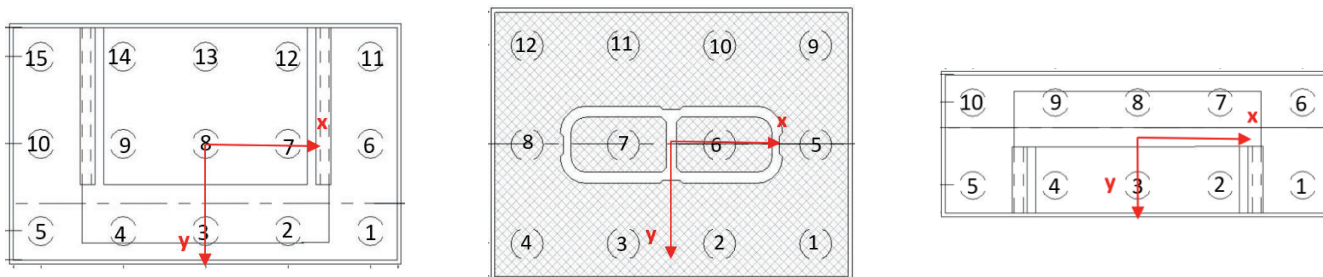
Sistema di riferimento per le fondazioni delle pile e delle spalle con indicazione della numerazione dei pali (da sinistra verso destra – Spalla 1, Pile 01 e 02, Spalla 2)
